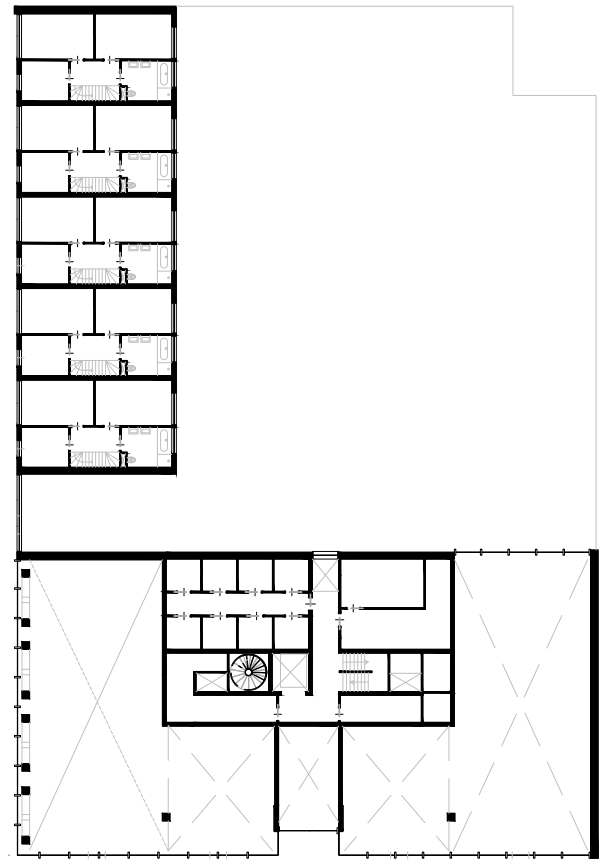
Plano de planta primera del edificio Patch 22 a escala 1: 500
